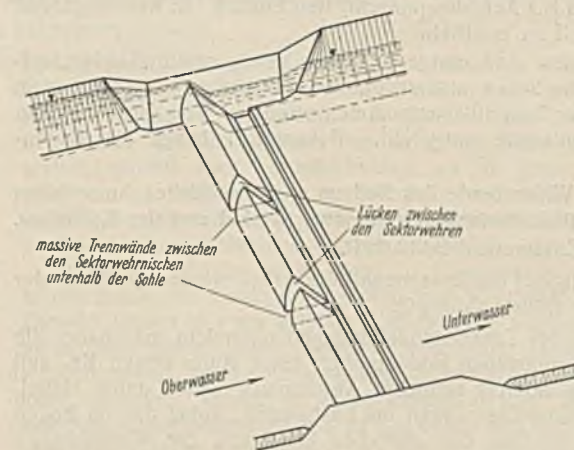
Schaubild eines Sektorwehres mit Lücken.
